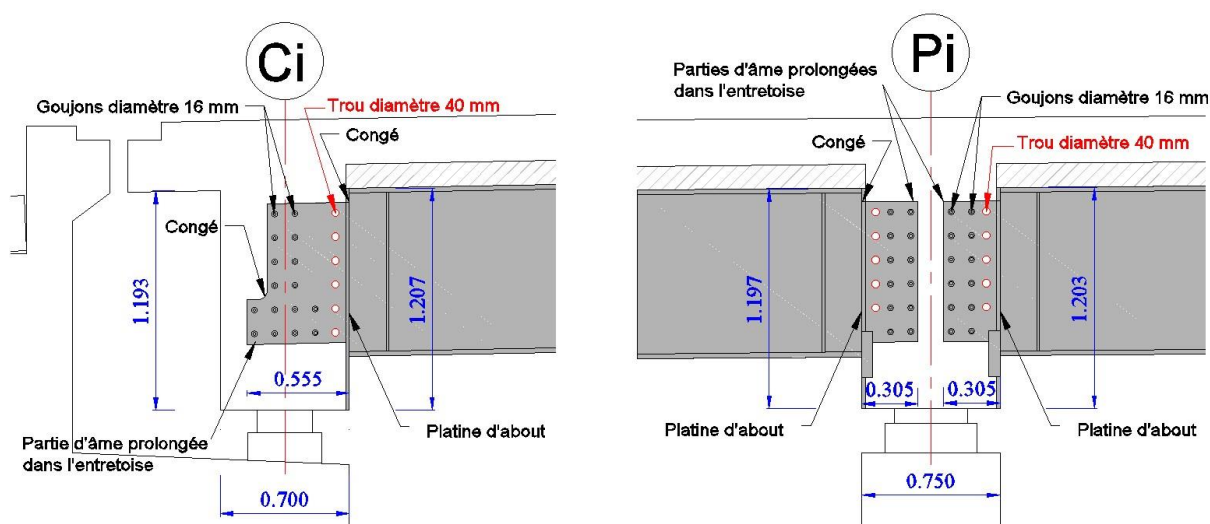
Connexion définitive poutre-caisson/entretoise béton, à gauche sur culée, à droite sur pile
